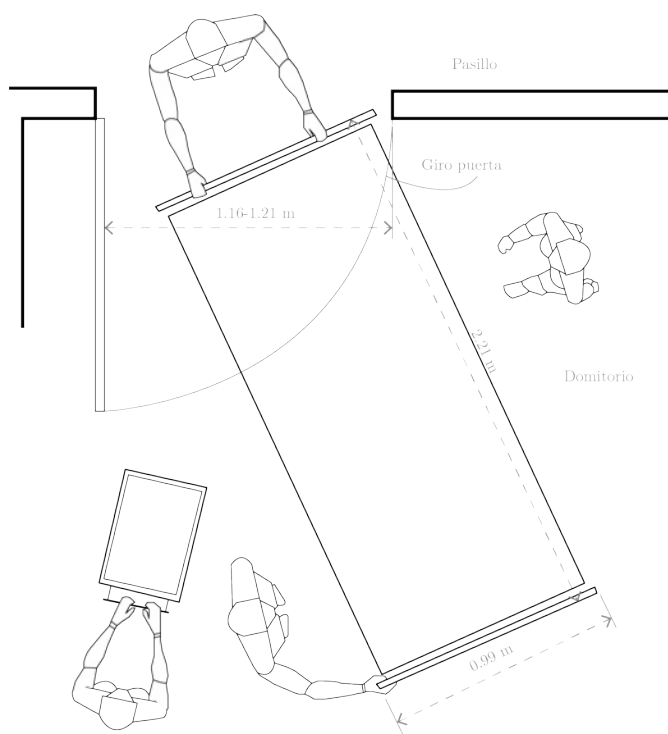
Puerta de acceso. Fuente: [Panero y Zelnik \(1979\)](#). Elaboración: Autores.
